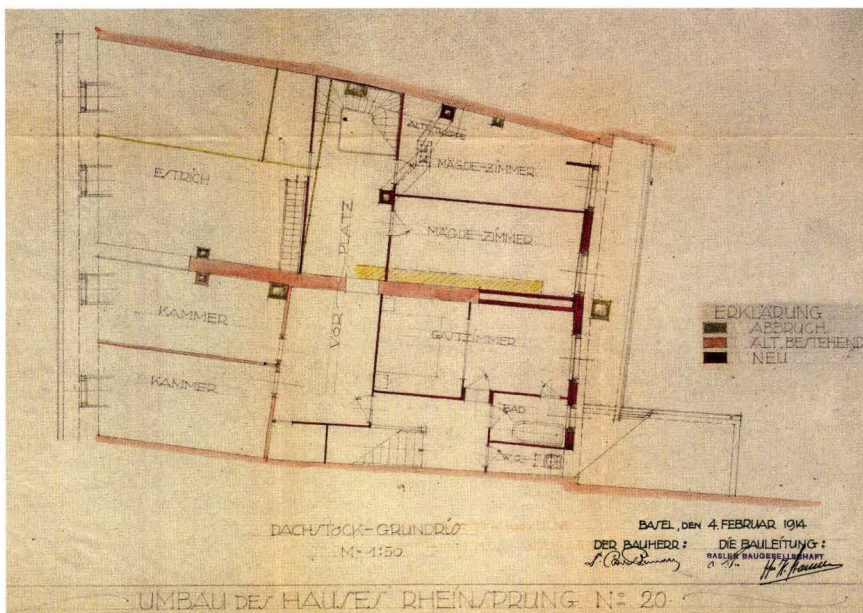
Rheinsprung 20 (2005/13). Grundriss Dachstock. Auf dem Umbauplan von 1914 sind abzubrechende (gelb), bestehende (rosa) und neue (rot) Bauteile markiert. So ist auch deutlich zu erkennen, dass die mittlere Brandmauer auf beiden Seiten um 4 m einspringt. Im Zuge der damaligen Umbauarbeiten wurde der hintere Teil dieser ehem. Giebelmauer mit seitlichen Mauerzügen (zwei rot dargestellte Streifen) Richtung Dachfläche ergänzt. – Baubegehren WW67, StaBS Bauplanausgabe.
